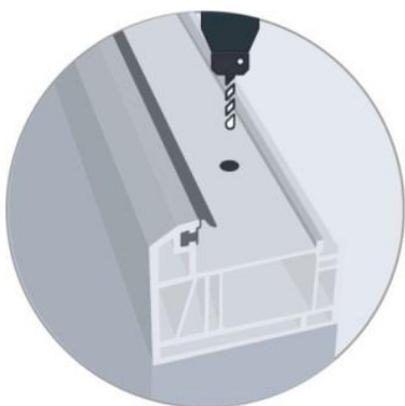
Разметка для установки исполнительного блока извещателя в раму окна или двери.
